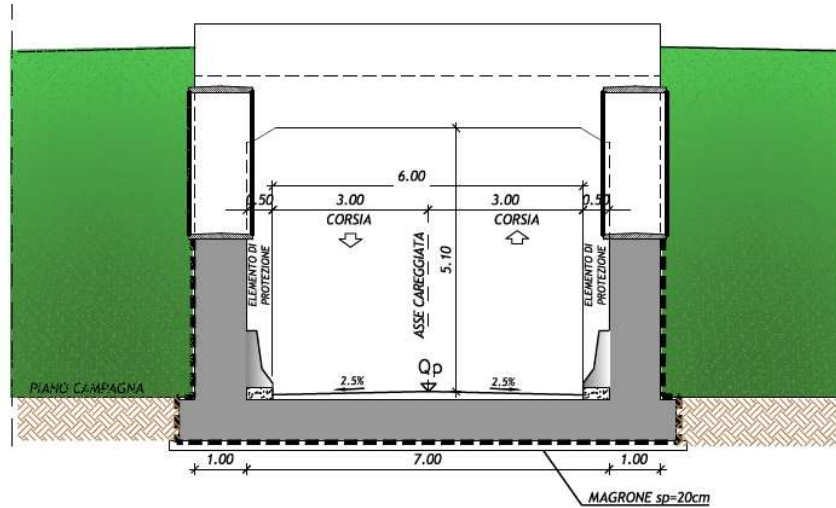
SEZIONE TIPO SCATOLARE APERTO
